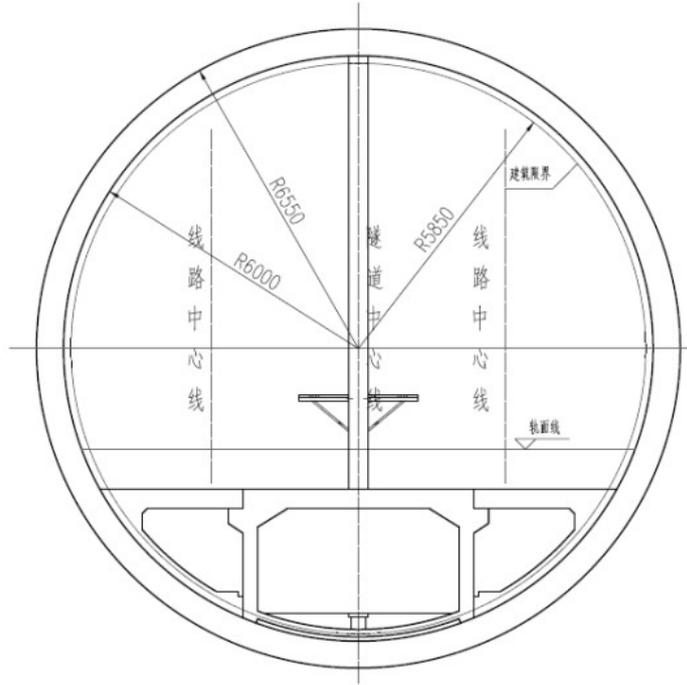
单洞双线盾构隧道横断面图（单位：mm）
